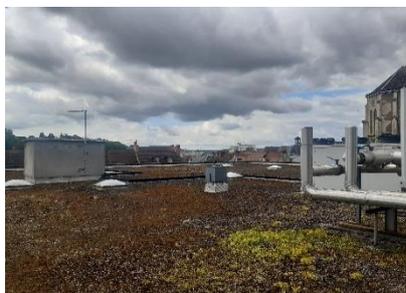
Toiture terrasse avec graviers du bâtiment D
